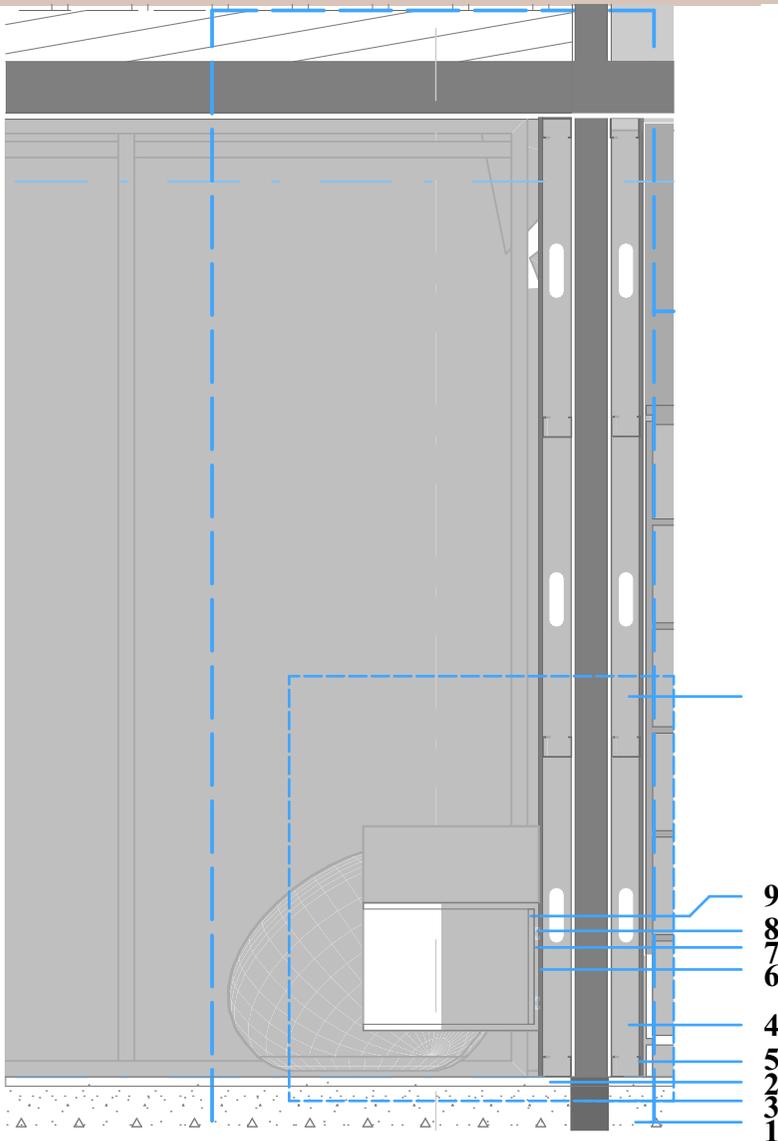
Detalle constructivo sección 3. Fuente: Autora.
